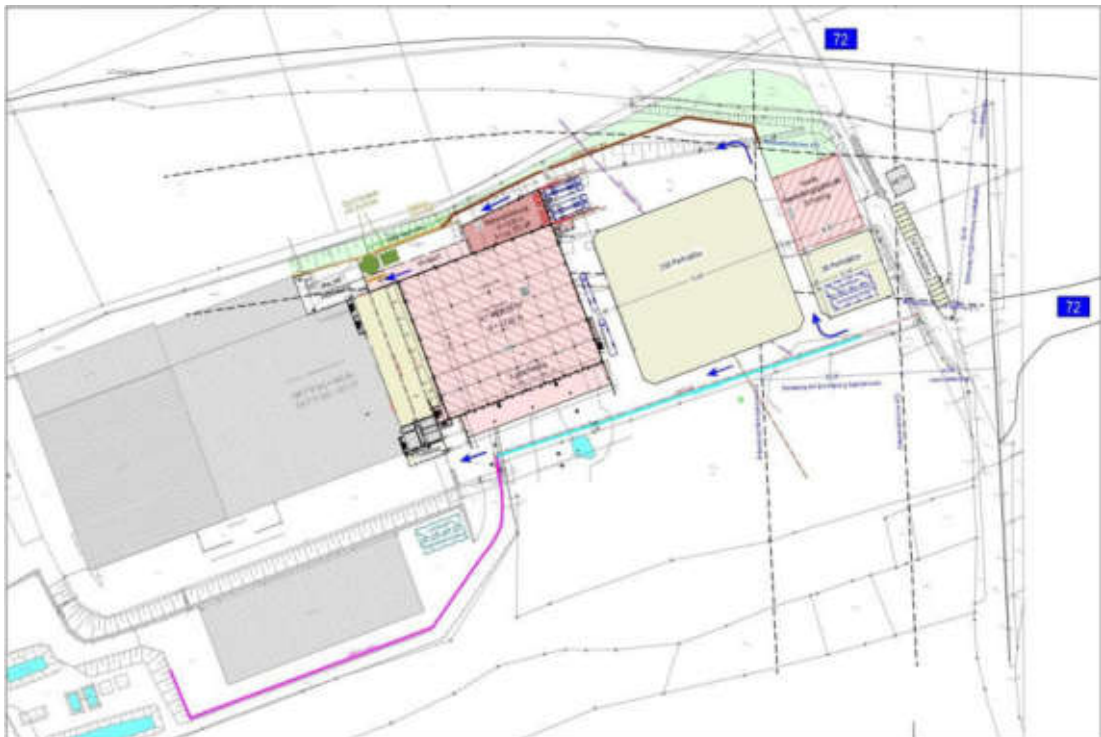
Entwurf Lageplan: Anbau Lagerhalle, Neubau Ausstellung 18.09.2023
